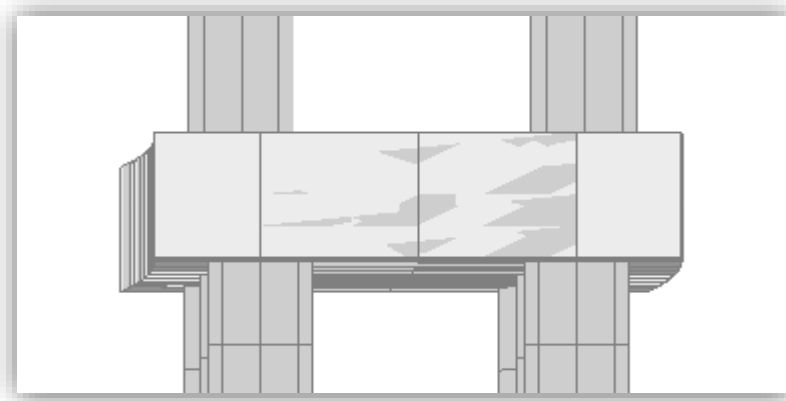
Vue en élévation de la semelle par RM BRIDGE.
